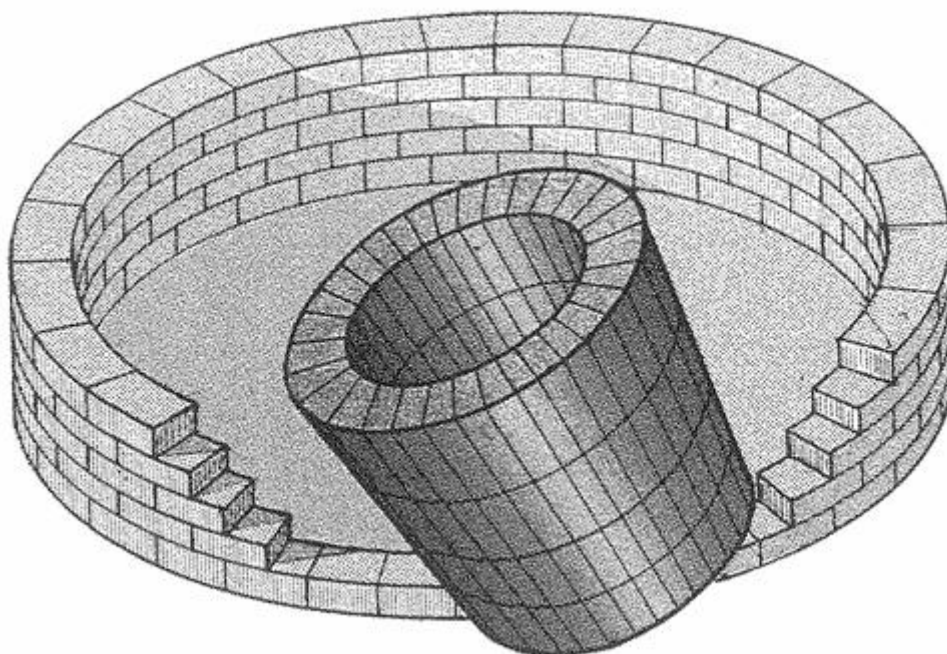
Elemento Construtivo do Tipo Cilíndrico
